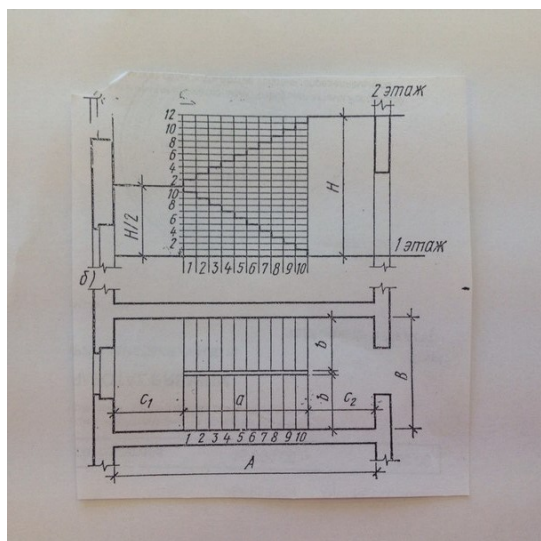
Схема разбивки лестницы: а-в разрезе; б- в плане.
